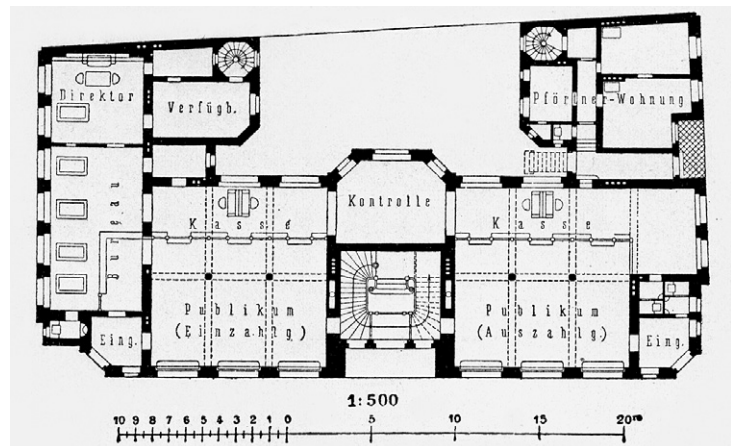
Erdgeschoss des Gebäudes des Danziger Sparkassen-Vereins (Mitte der 1880er Jahre erbaut)
